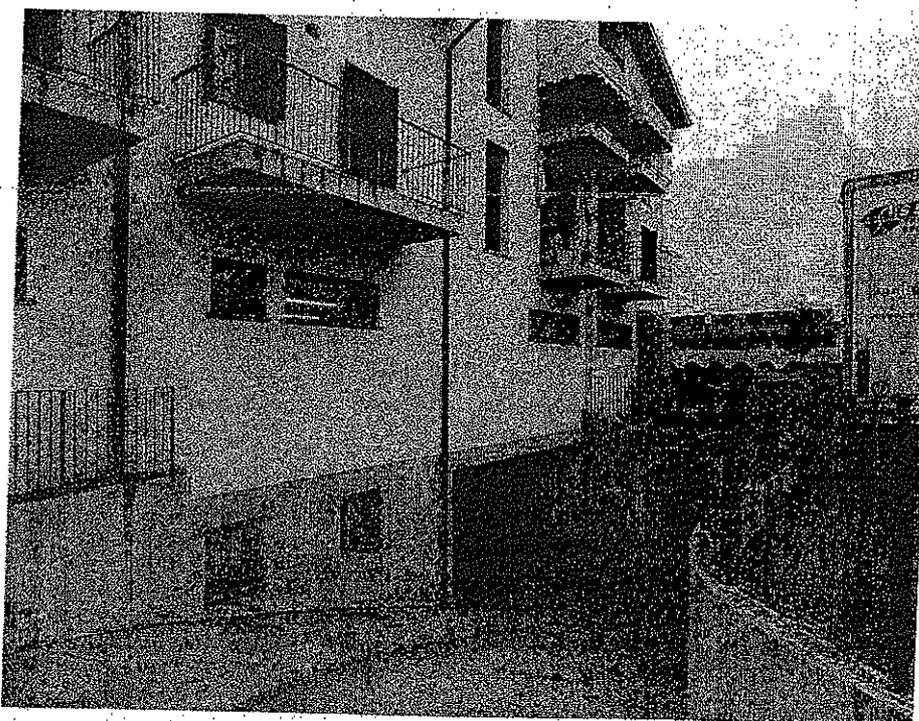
Esterno dell'appartamento e rampa di accesso condominiale al garage
